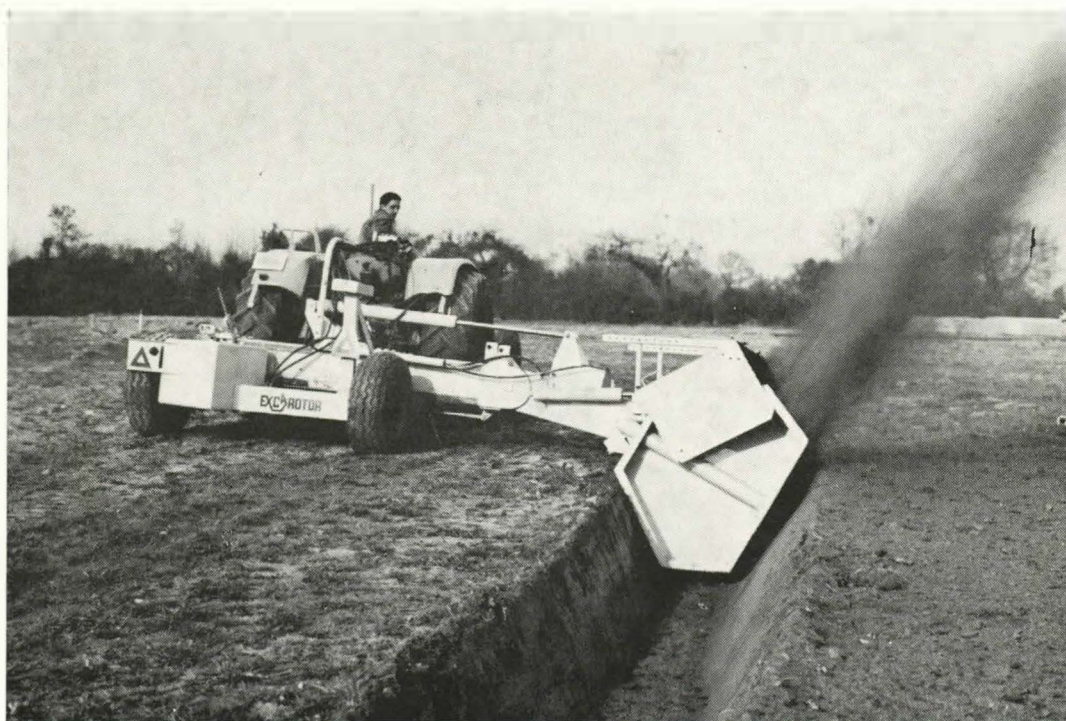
Vue de l'Excavator de CERIMON travaillant en déport (Photo Constructeur).
